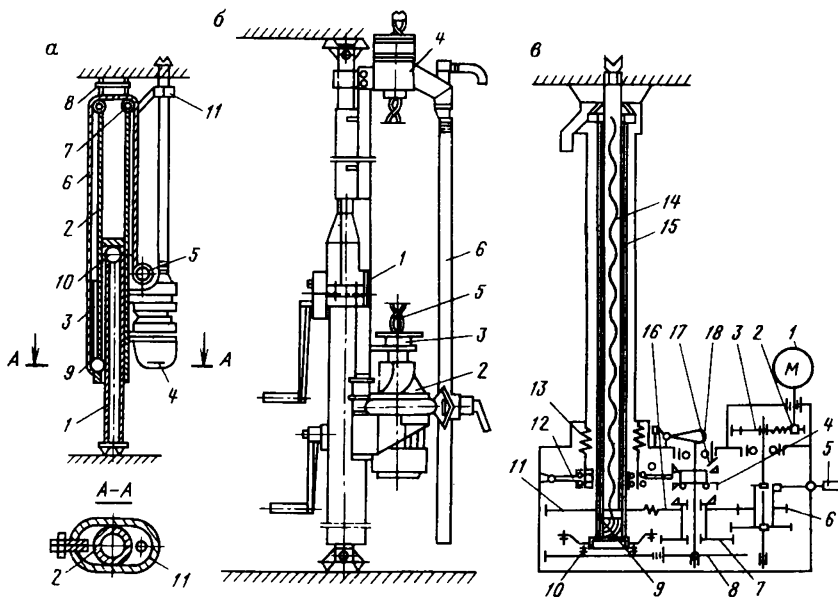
Усовершенствованные станки для бурения скважин под анкерную крепь конструкции:
